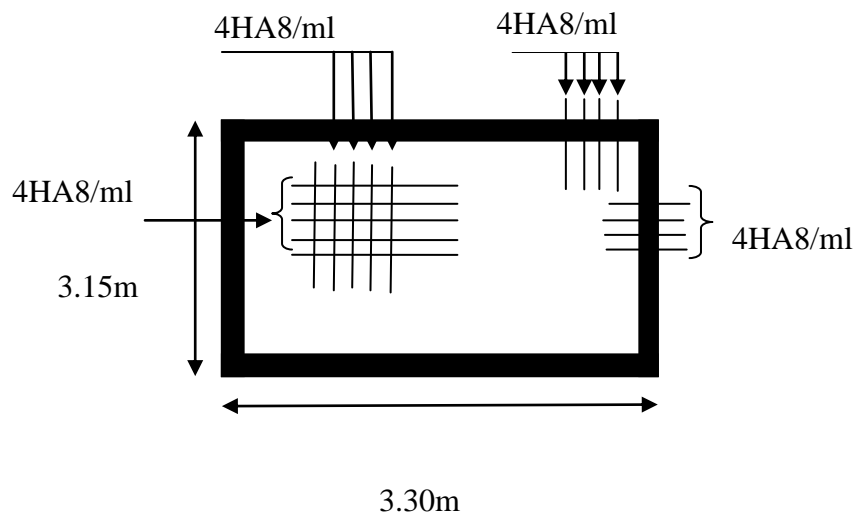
Schéma de ferrailage de la dalle pleine sur 4 appuis
